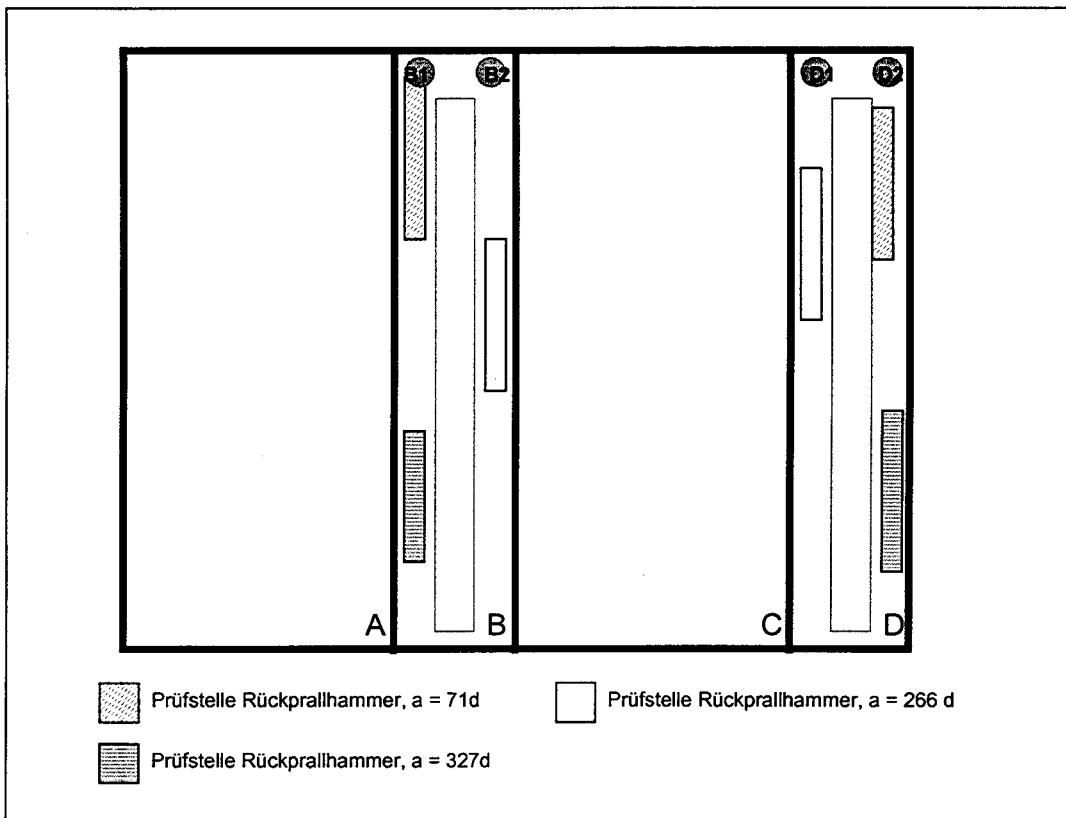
Lage der Prüfflächen am Betonkörper 13
